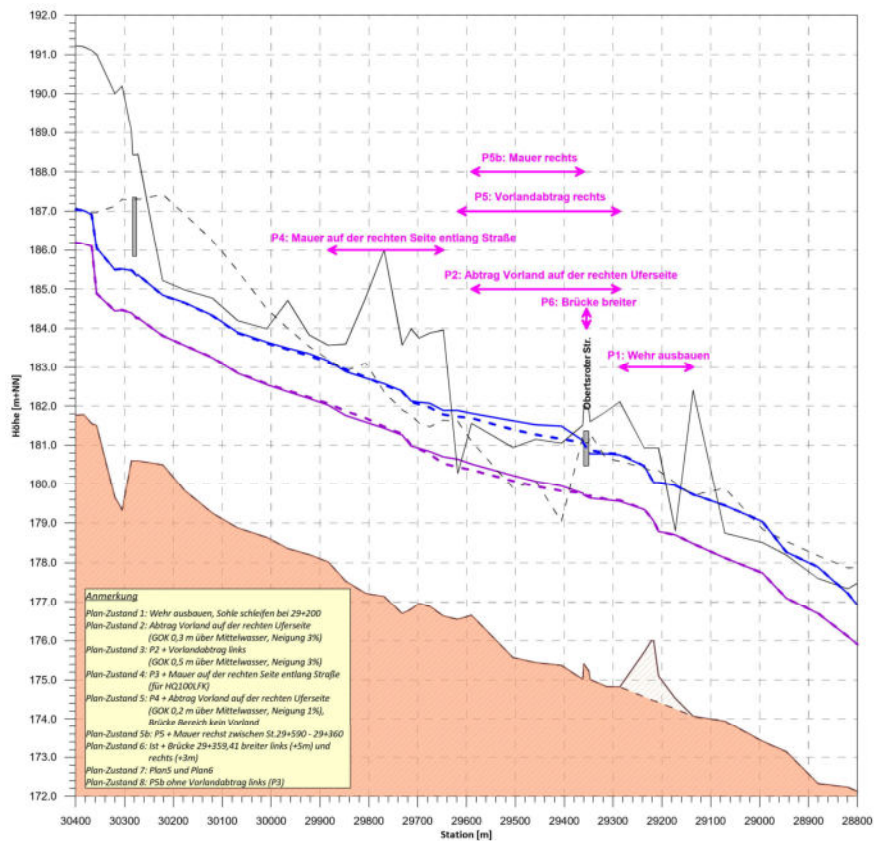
Wasserspiegellängsschnitt Murg Hilpertsau, Ist-Zustand und Plan 8
